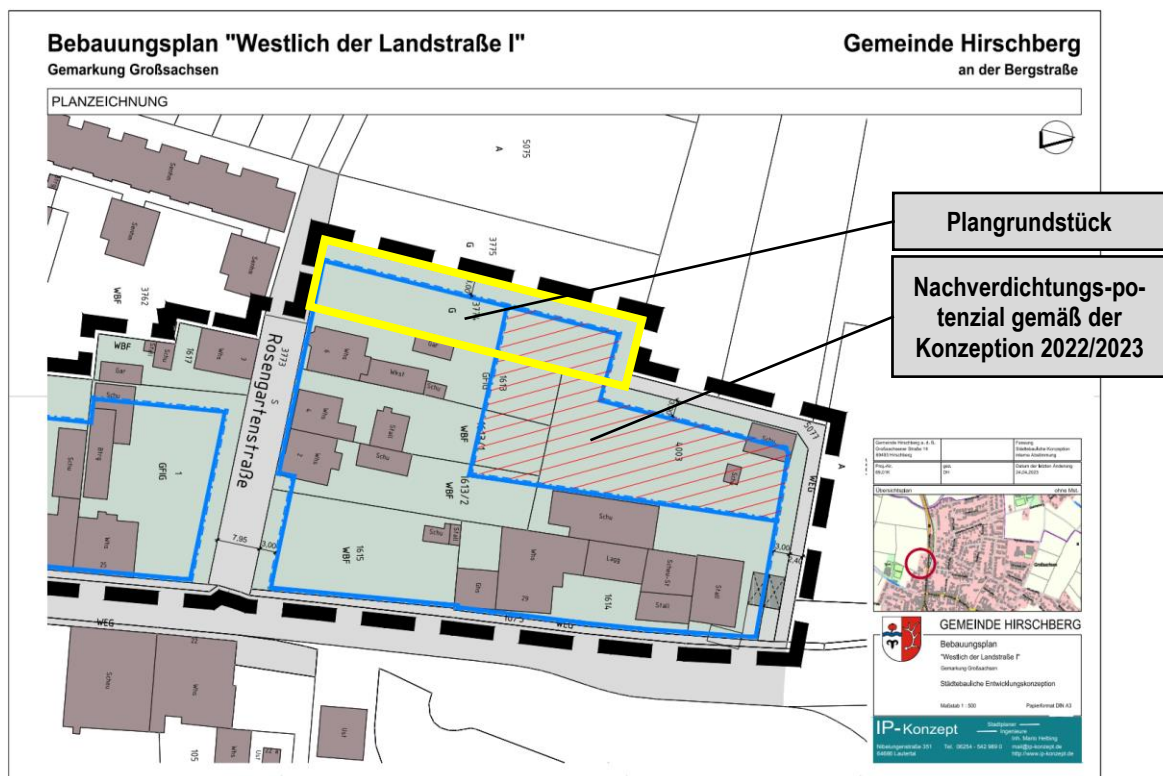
Städtebauliche Konzeption für den Bebauungsplan „Westlich der Landstraße I“
